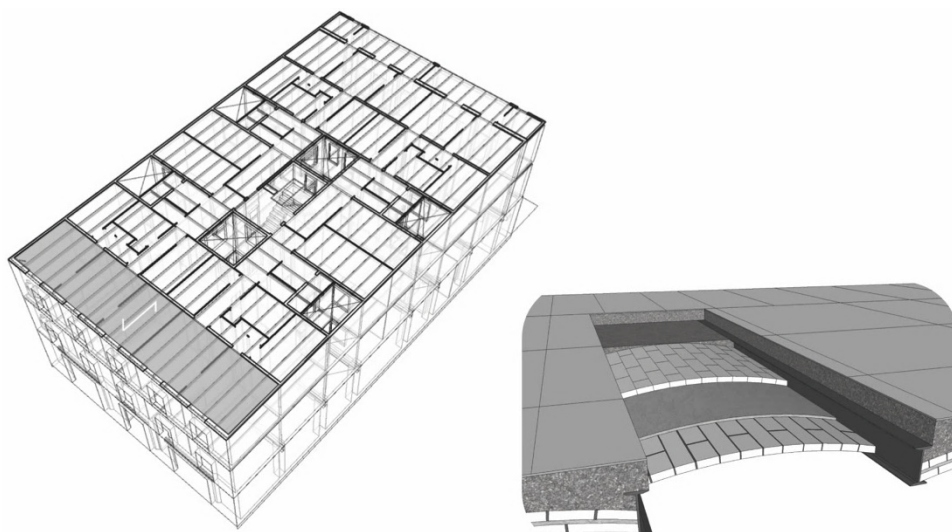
Sistema de forjado unidireccional a base de viguetas metálicas y bovedillas cerámicas (fuente: elaborado por el autor)
